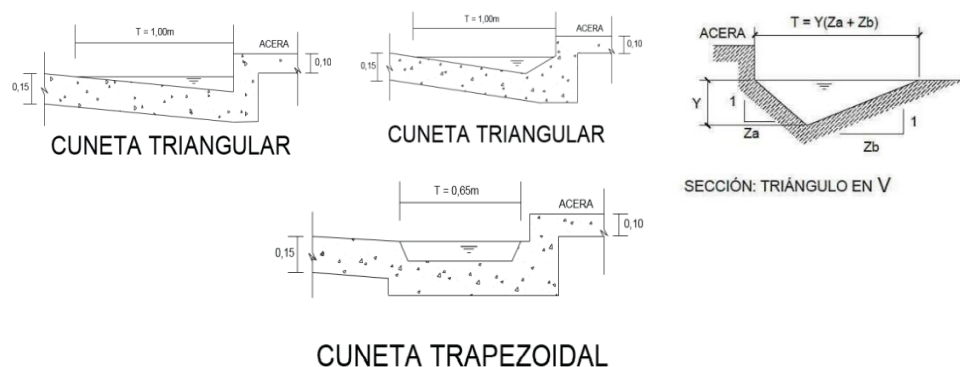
Tipos de Sección de Cunetas en el Drenaje Pluvial [24]
